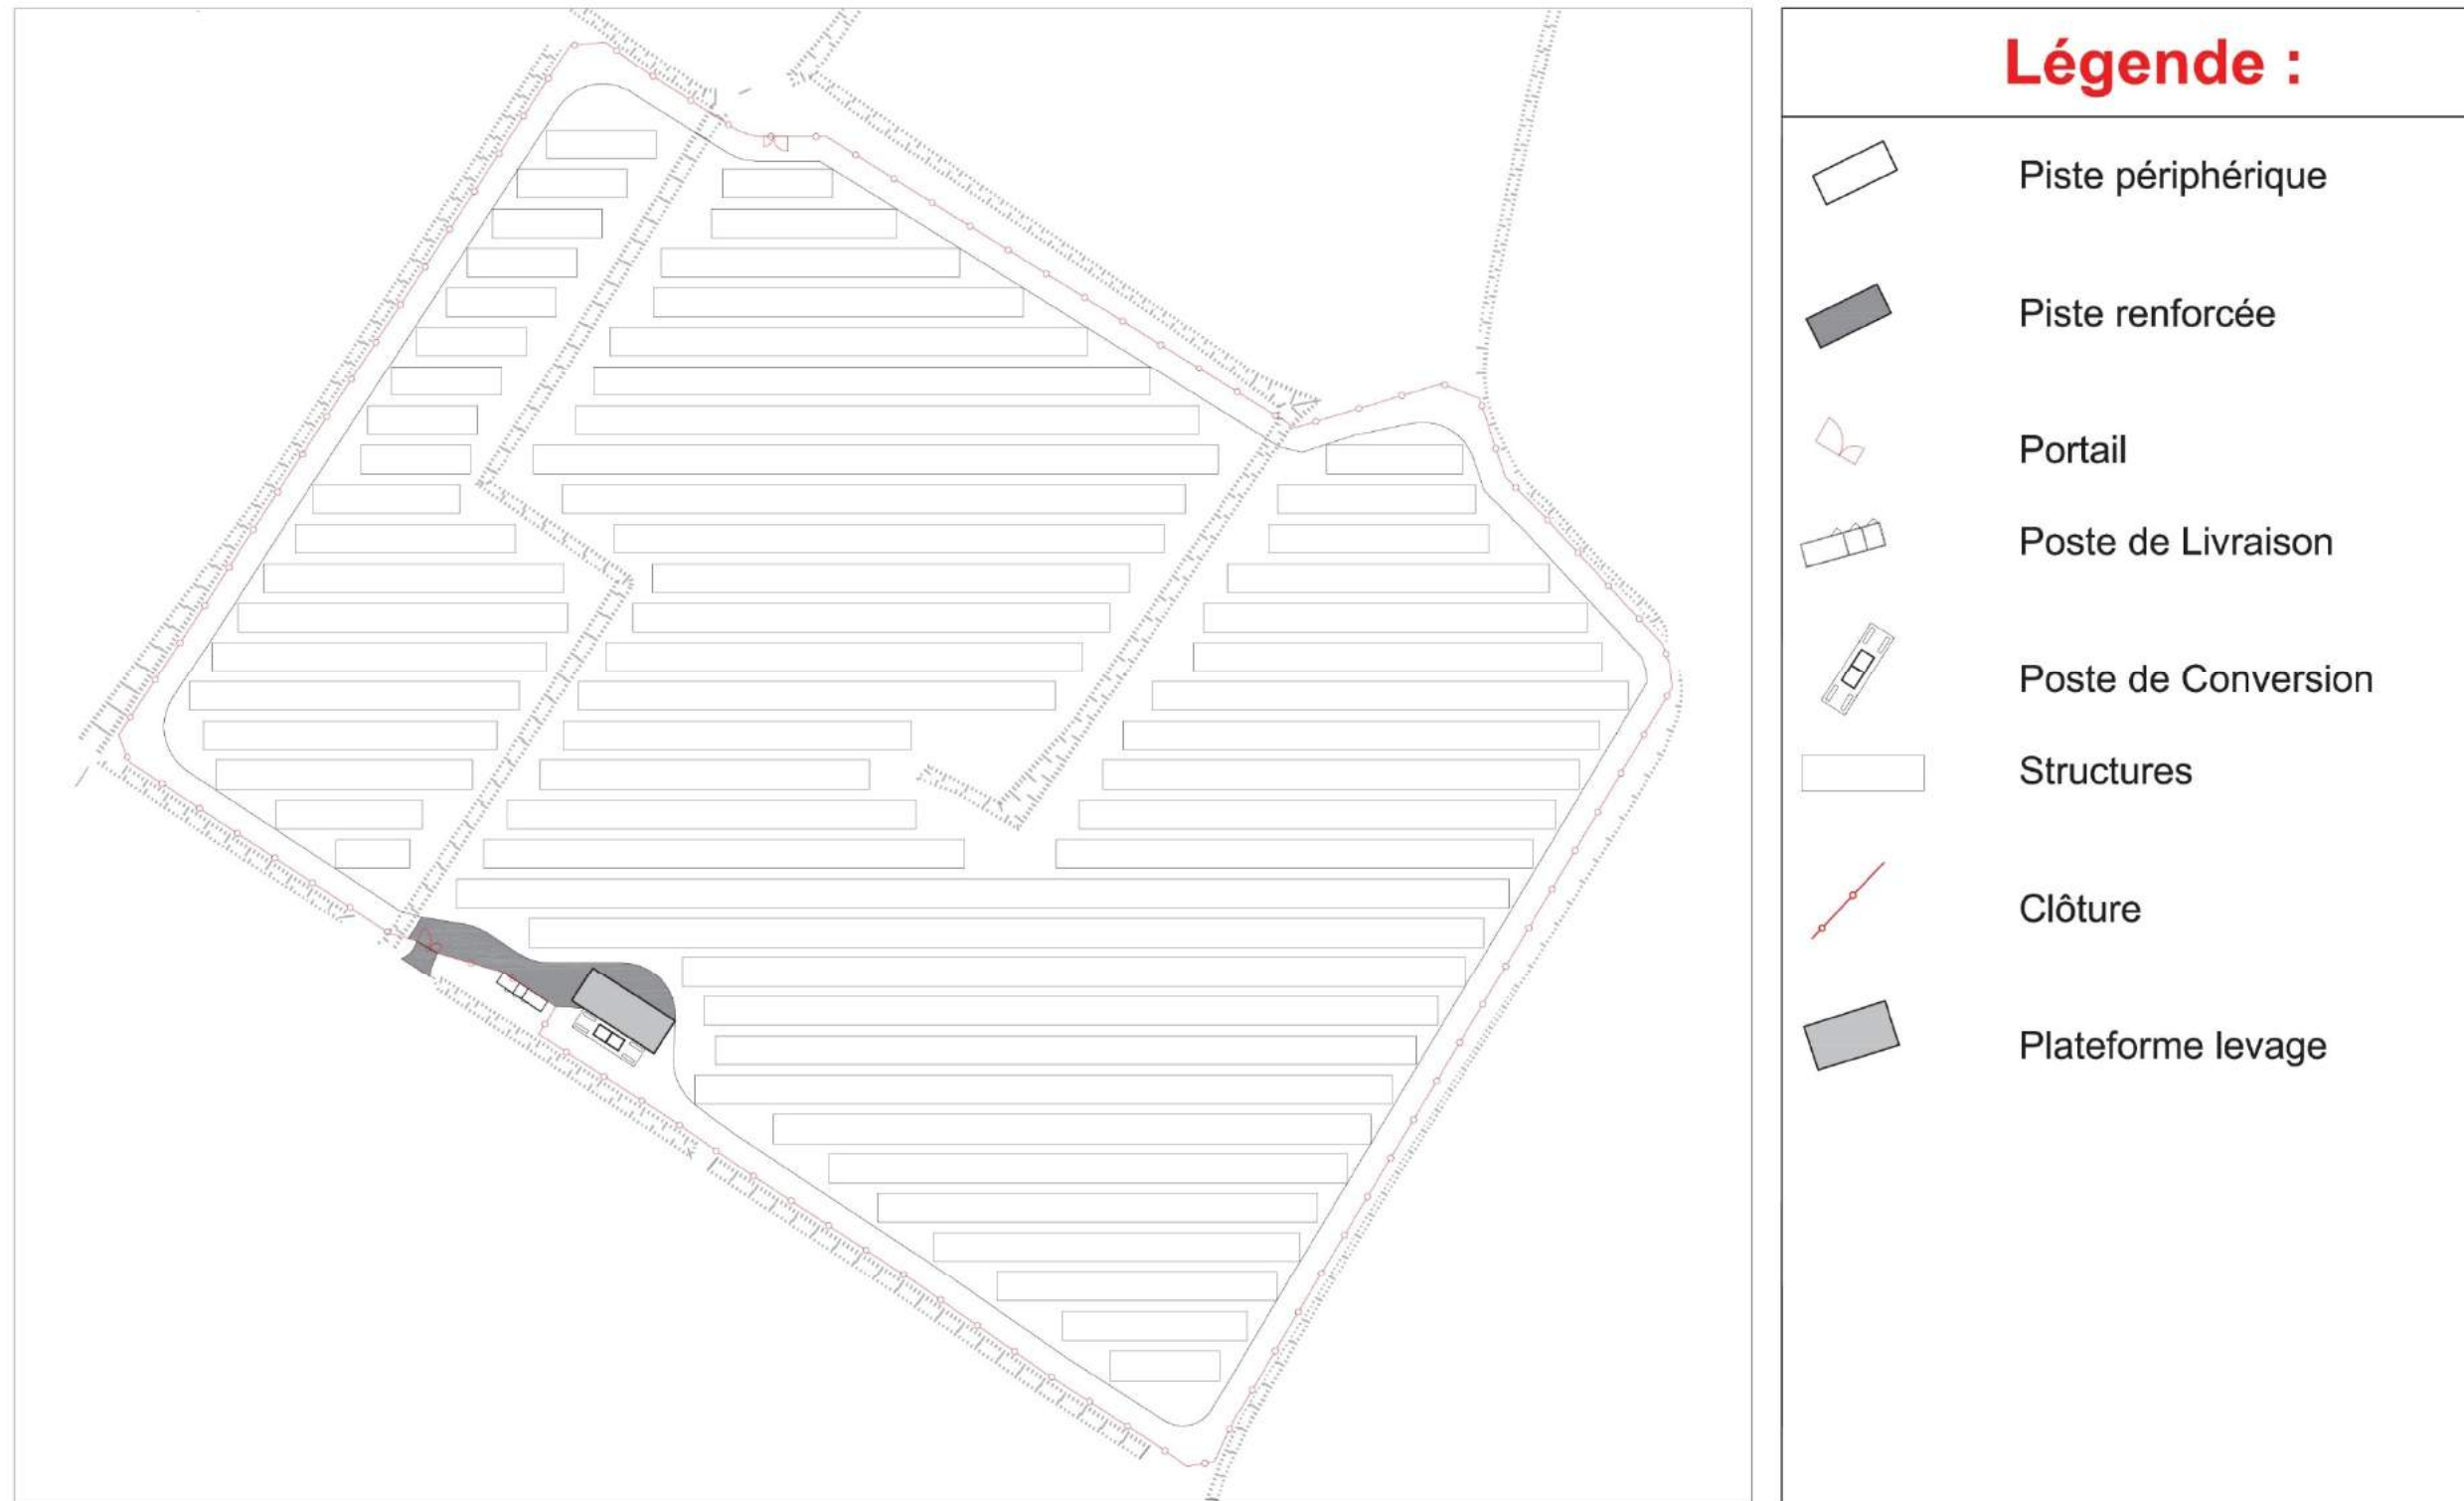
Plan de masse de la centrale photovoltaïque de Fendeille
